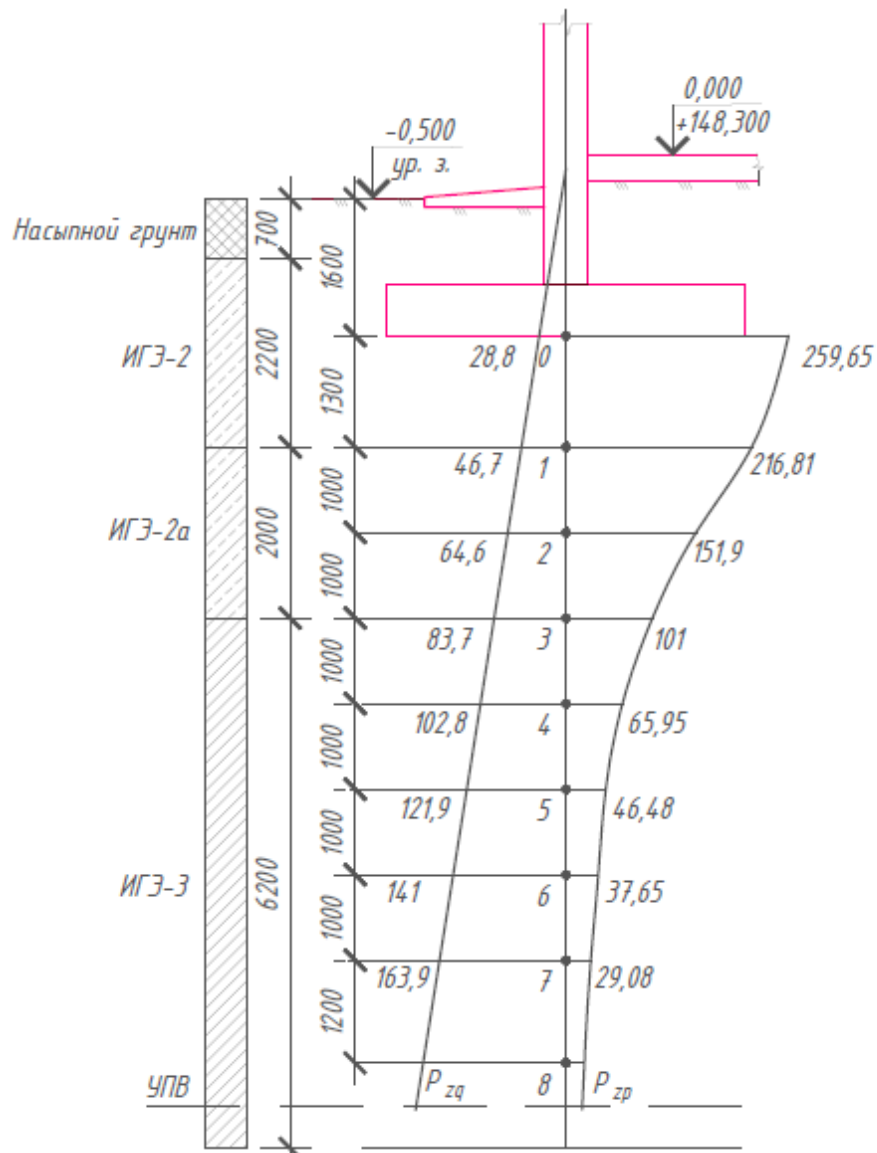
Расчетная схема к определению осадки фундамента методом послойного суммирования под наружную колонну (в осях Б/10)
